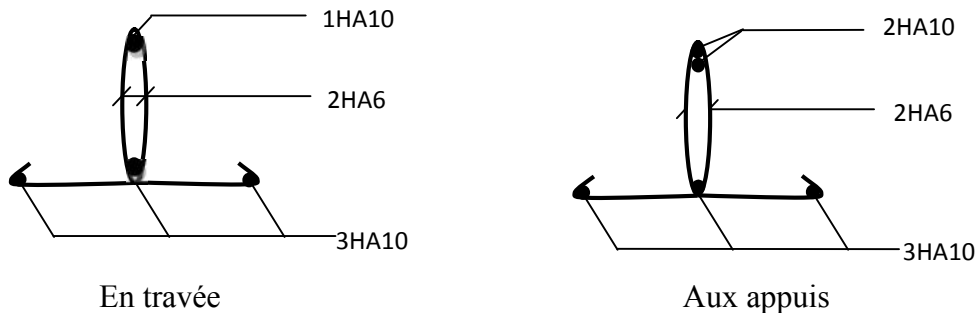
Plan de ferrailage de la poutrelle en travées et aux appuis
